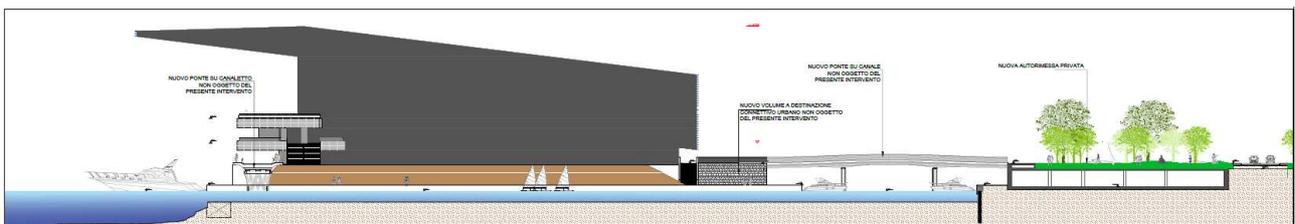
Sezione lungo il Canaletto e prospetto del Padiglione Nouvel (stralcio della tavola T08-D-Ar del Progetto Definitivo).
